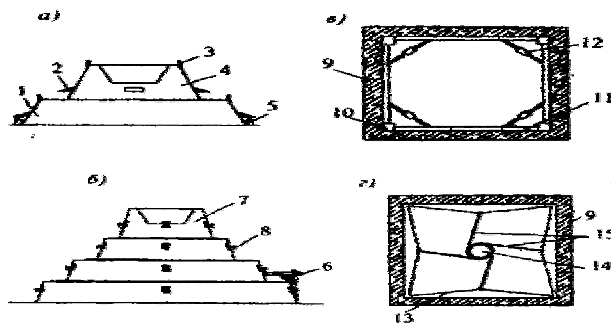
Блок-форми і блочні опалубки: а – нероз'ємні блок-форми фундаменту; б – роз'ємна блок-форма фундаменту; в – крупноблочна опалубка із стяжними муфтами; г – тяж, з гнучкими щитами; 1 – блок підколонника; 2 – кронштейн для упора домкратів; 3 – монтажна петля; 4 – блок виступу фундаменту; 5 – домкрат; 6 – відбивний пристрій; 7 – замок; 8 – блок-форма сторони фундаменту; 9 – конструкція, що бетонується; 10 – елемент каркасу опалубки; 11 – щит опалубки; 12 – стяжна муфта; 13 – гнучкий щит опалубки; 14 – центральна поворотна стійка; 15 – тяги до щитів
